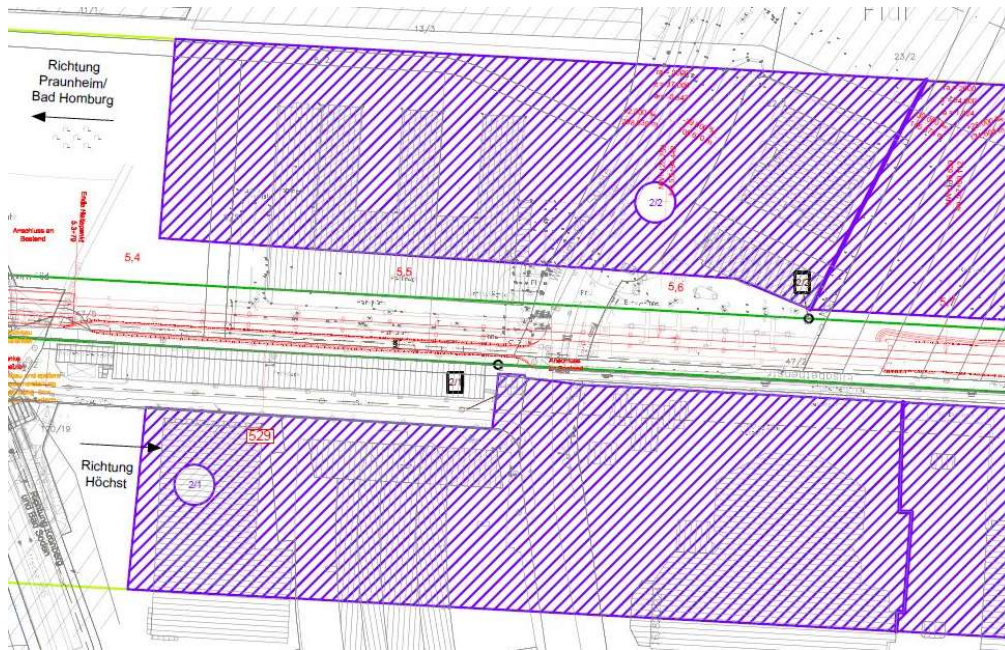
Planausschnitt Eschborn Mitte 2 mit dem maßgeblichen Minimierungsort 1
